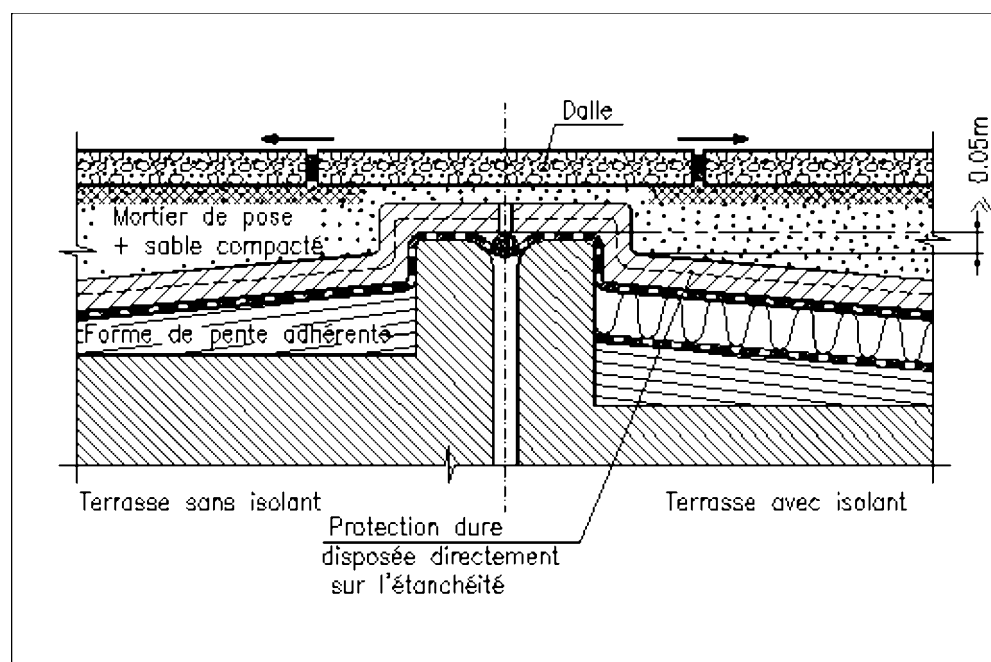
Exemple de joint plat surélevé - Terrasse accessible avec protection dure traditionnelle
